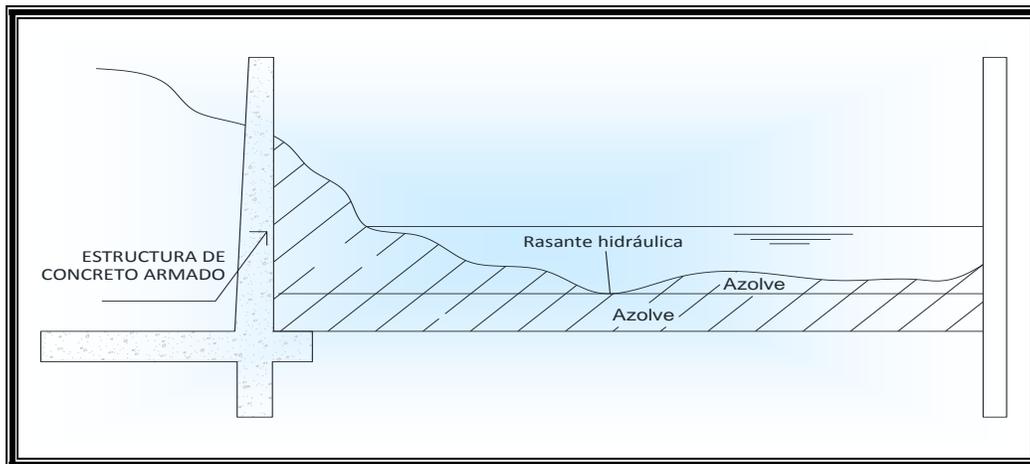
Estructura de concreto en localización en Cauce del Río.
